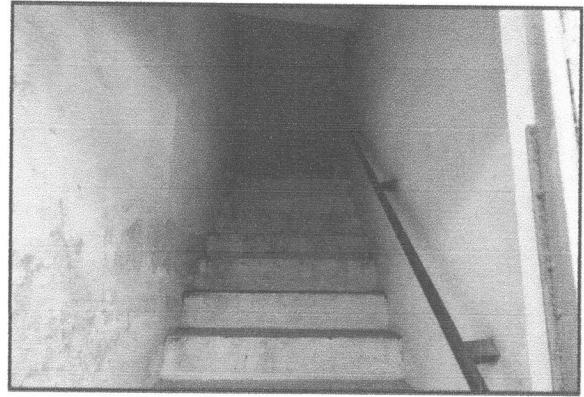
Imagem de escada de acesso ao pavimento superior, com corrimão em madeira
